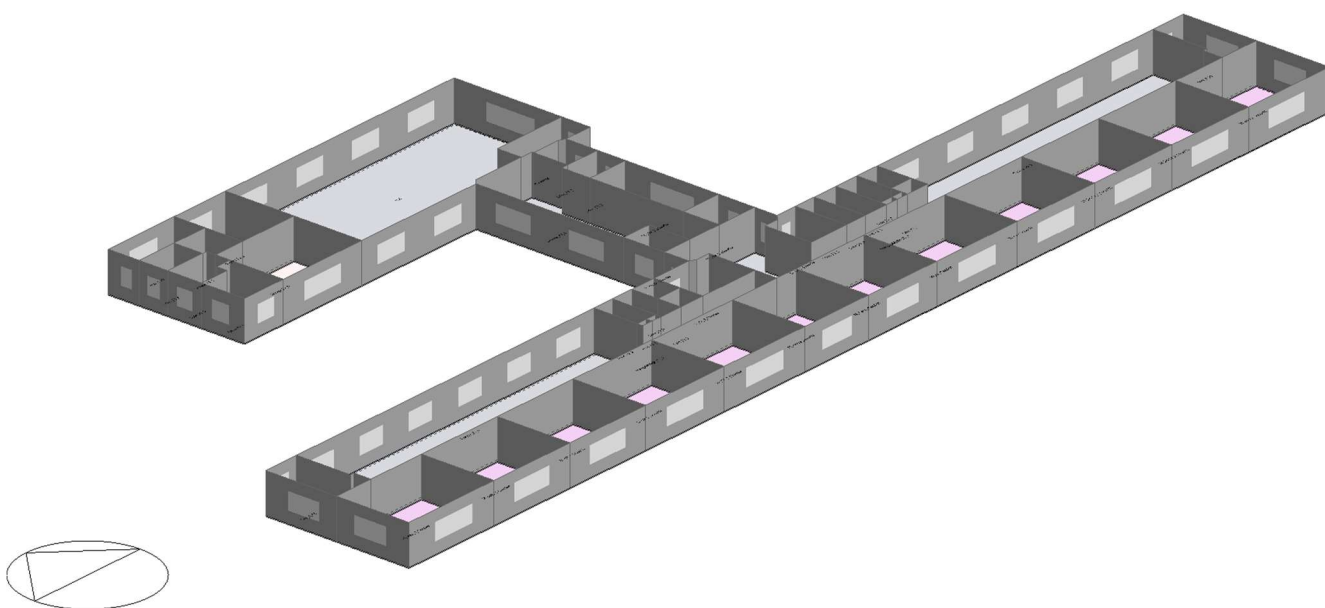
Геометрія будівлі у програмі DesignBuilder, другий поверх
